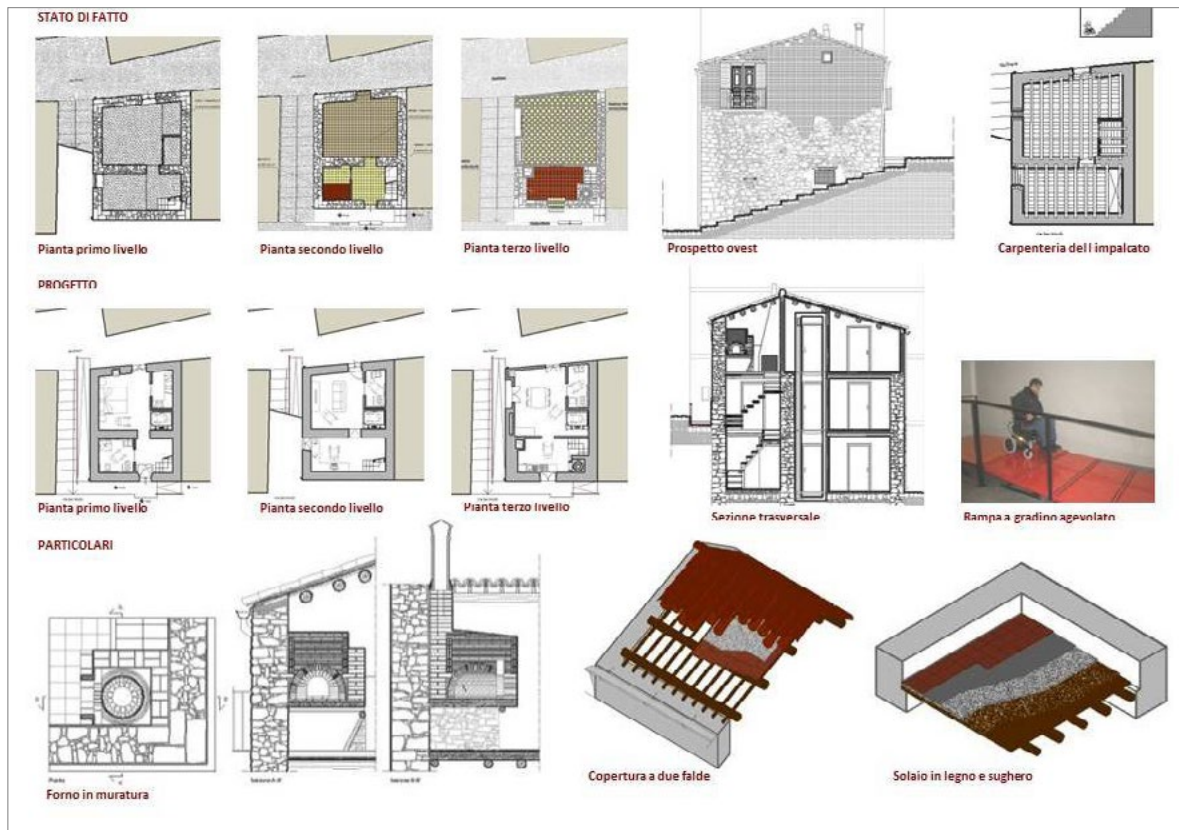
Adattabilità e abbattimento delle barriere architettoniche nell'edilizia storica (disegni e elaborazione di E. Caleca, tesi di laurea *San Mauro Castelverde, smart town? La sicurezza come requisito del progetto di recupero. La casa per diversamente abili*, Eleonora Caleca, Università degli studi di Palermo, Facoltà di Architettura, Corso di laurea in Restauro, Recupero e Riqualificazione dell'Architettura, relatore A. Mami, correlatore R. Prescia, a.a. 2011-2012).
